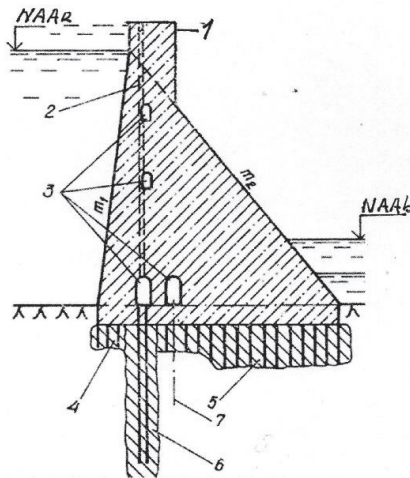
Perfil transversal de una presa de hormigón a gravedad.
